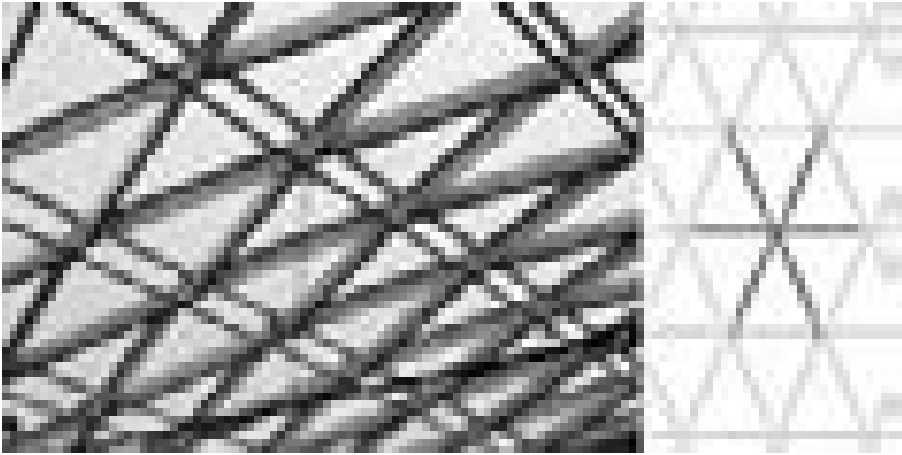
Junkers-Stahllamellendach, Stabnetzlogik und Grundelement; musealer Wiederaufbau für das Technikmuseum Hugo Junkers in Dessau
